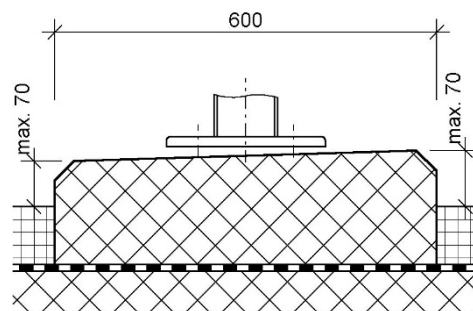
Semelle en béton sur l'étanchéité du pont, sur le terre-plein central d'un pont à tablier unique
